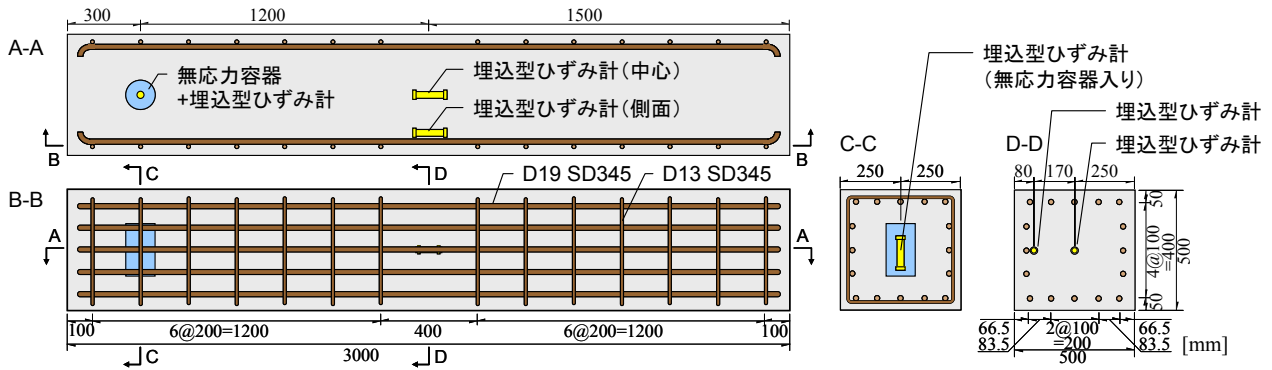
梁モデル供試体の形状寸法 および 計測機器の配置
